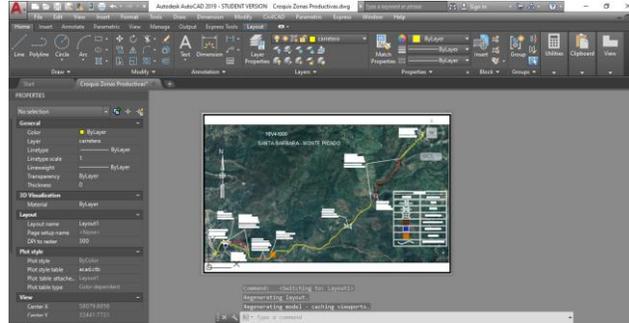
Croquis tramo 16V41000 “Santa Bárbara – Monte Picado”
